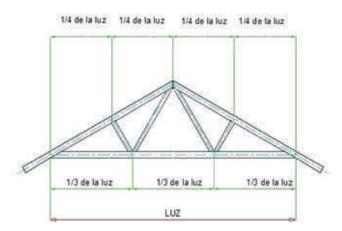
Cercha tipo Fink, con los elementos cortados y presentados para su fijación.
